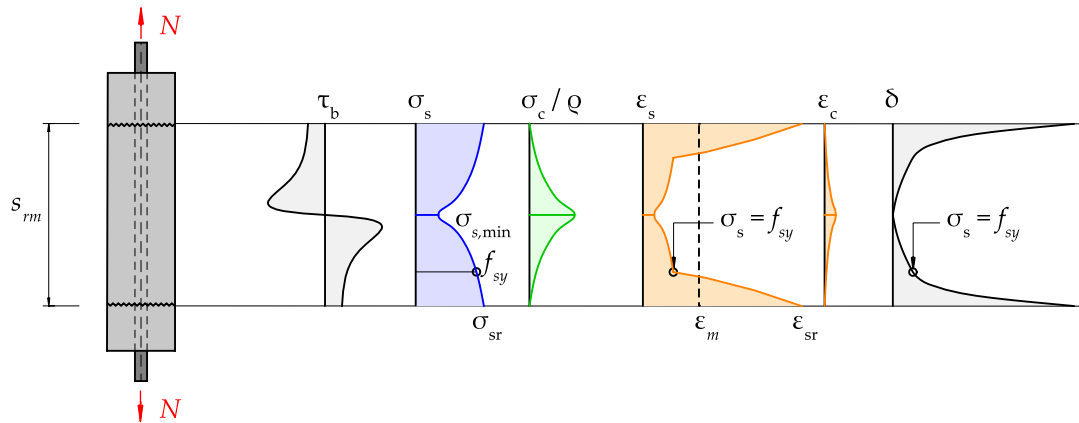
Verlauf der Verbundschubspannungen, Betonstahlspannungen, Betondehnungen, Betonstahldehnungen und Schlupf bei einem Zugversuch. Bild neu gezeichnet nach [2]
